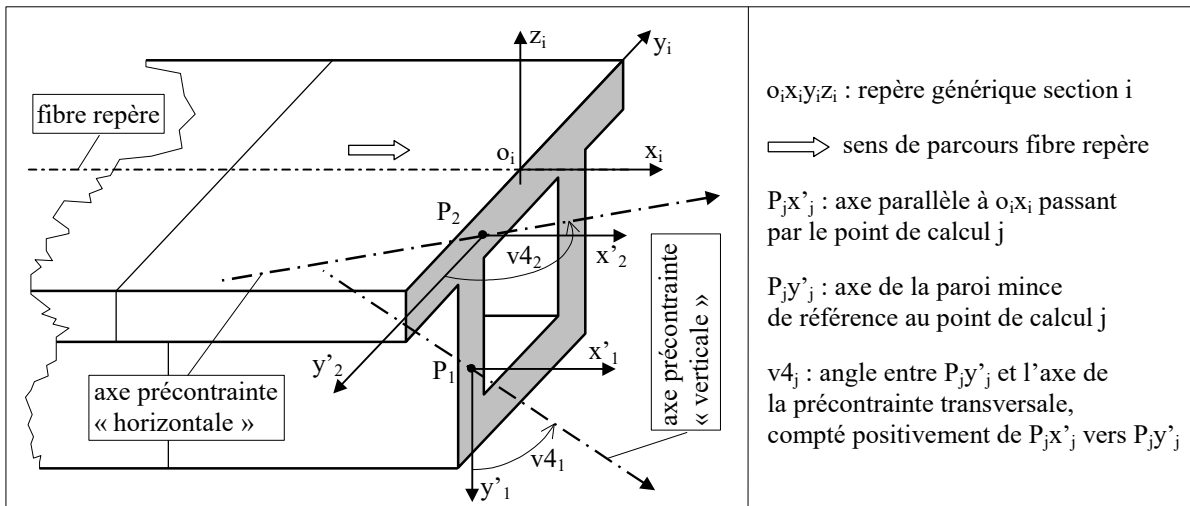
Précontraintes transversales d'une section de poutre, conventions
